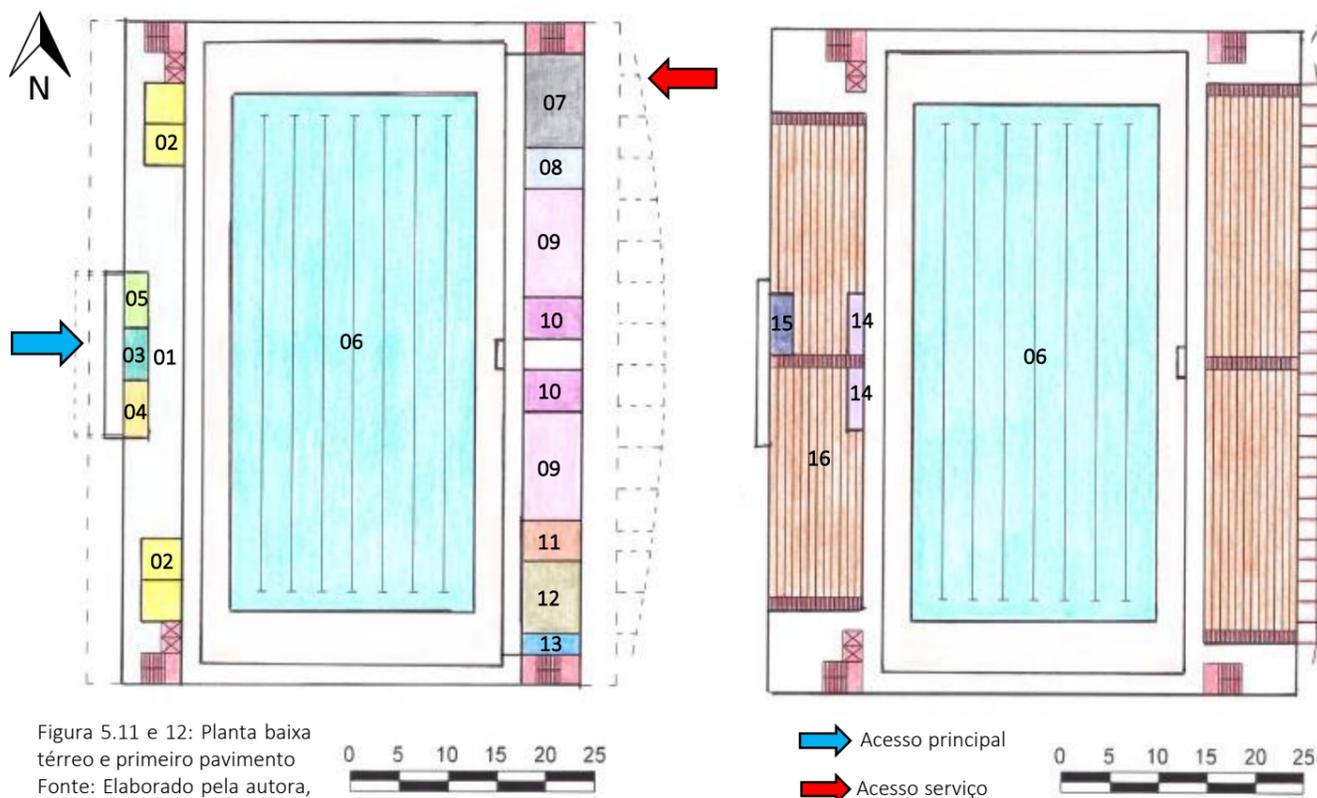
e 12: Planta baixa térreo e primeiro pavimento
